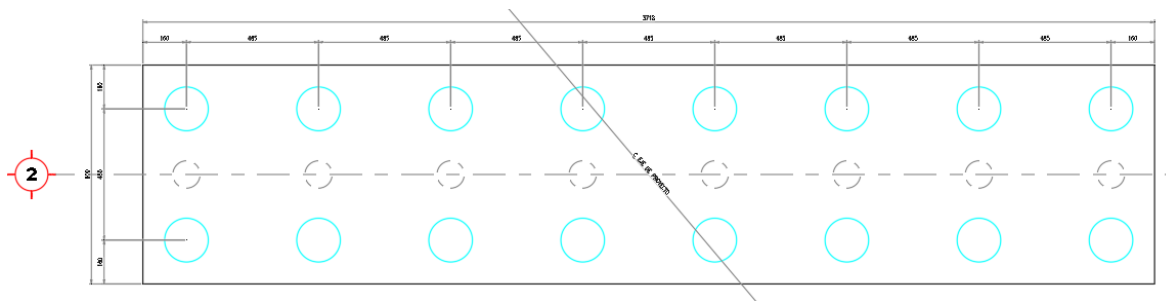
Vista en planta de zapata de cimentación con apoyo central
